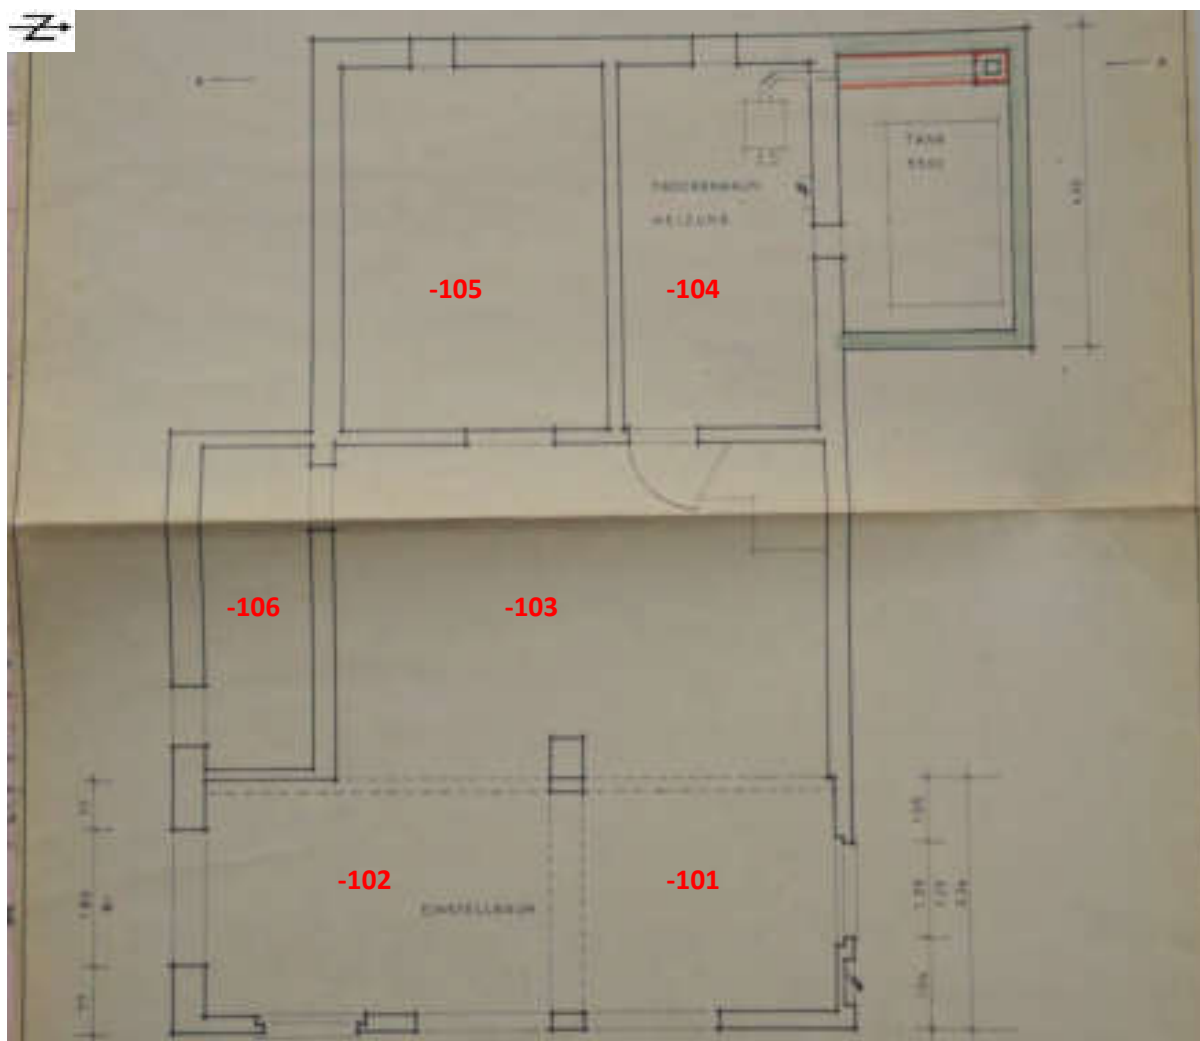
Grundriss UG. Quelle: GdeA.
